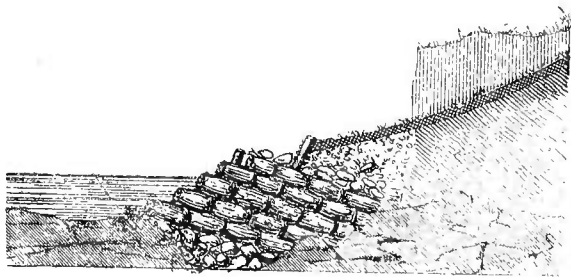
Clayonnage mixte d'une rive à pic avec enrochement.
